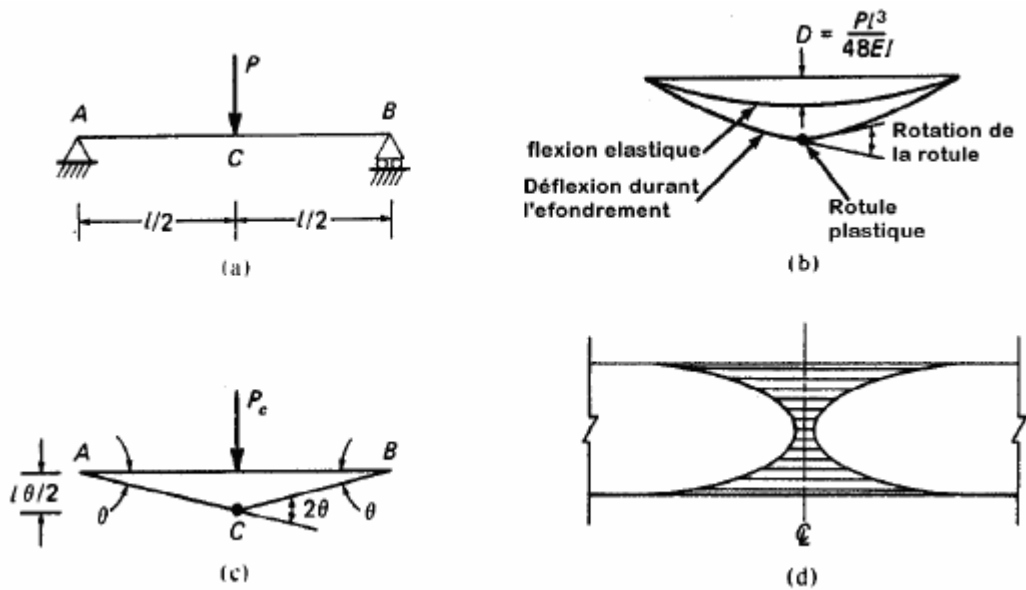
Comportement plastique d'une poutre simple, (a) poutre, (b) lignes de flexion, (c) changement dans la flexion pendant l'effondrement, (d) faisceau montrant la fragilité de la poutre dans sa section à mi-travée
